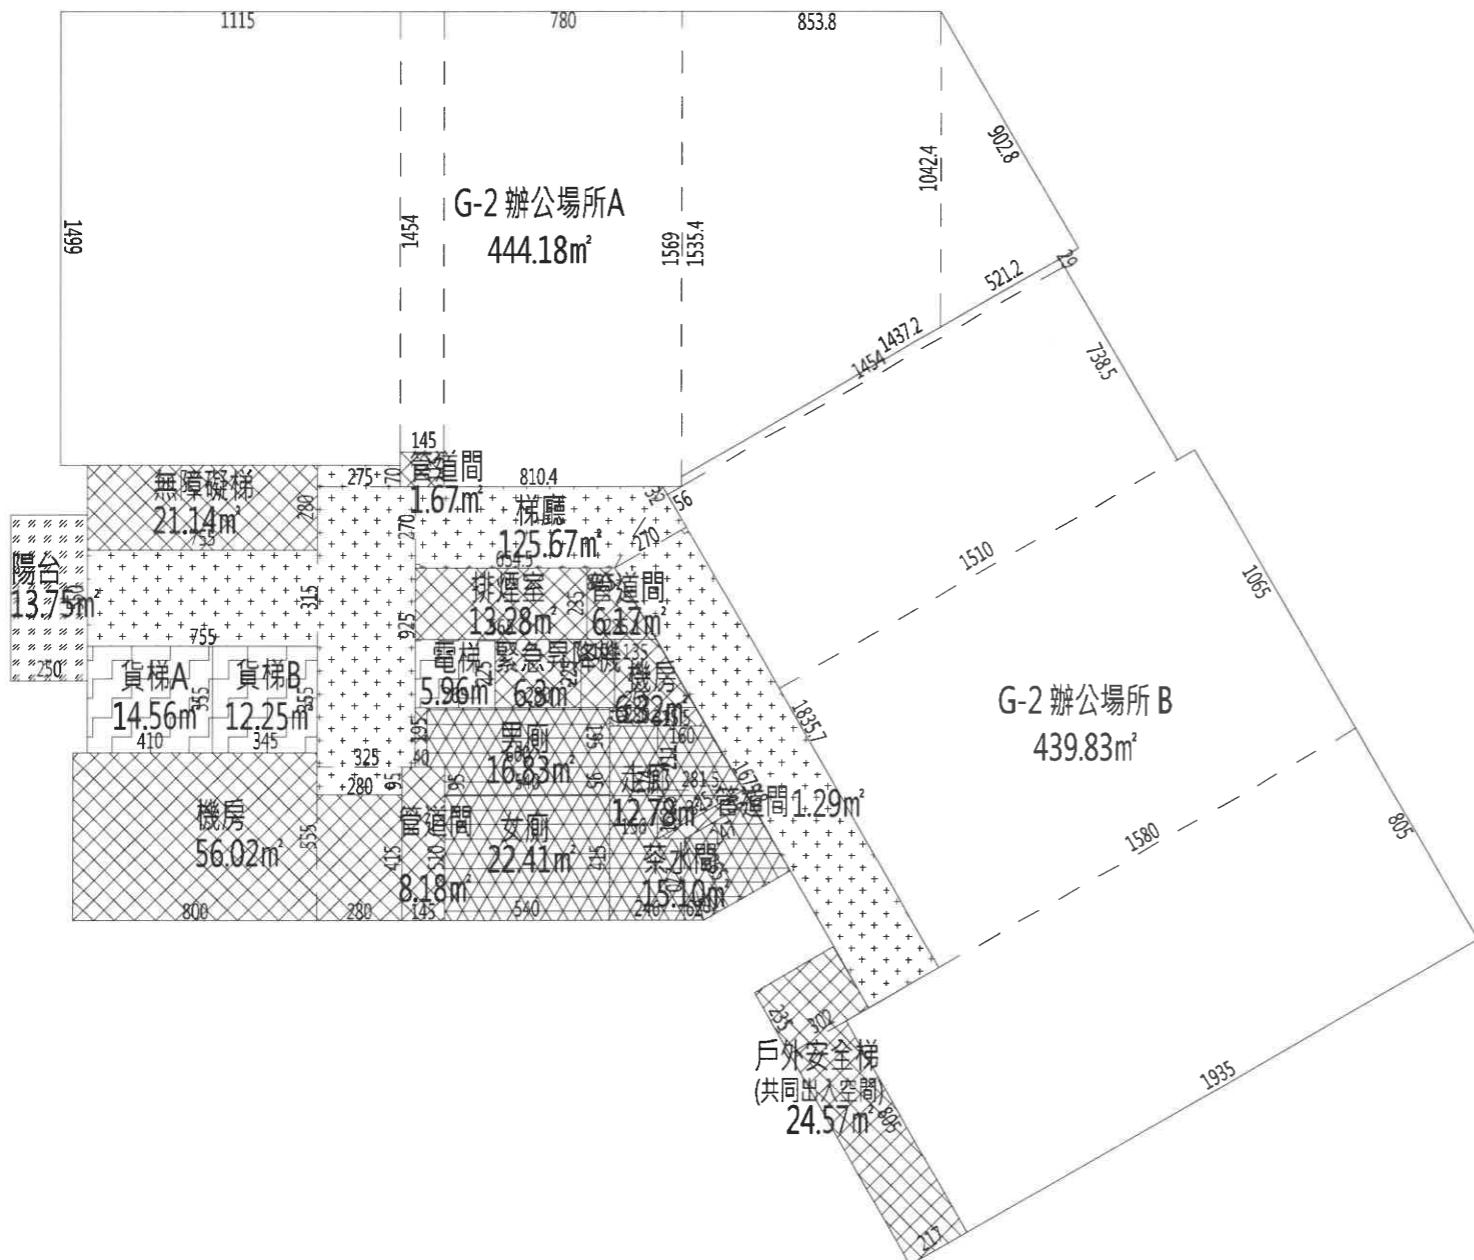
地上十一層平面圖(變更後)(S : 1/300)
